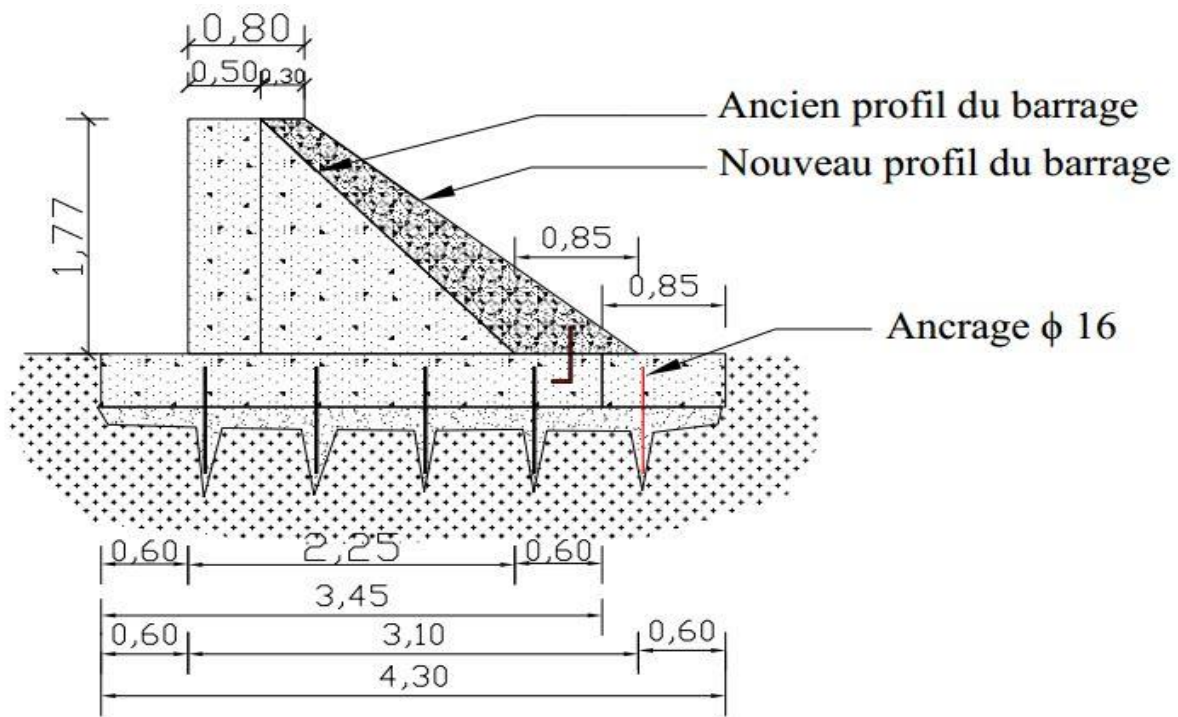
Nouveau profil du barrage avec la canne d'ancrage à la fondation
